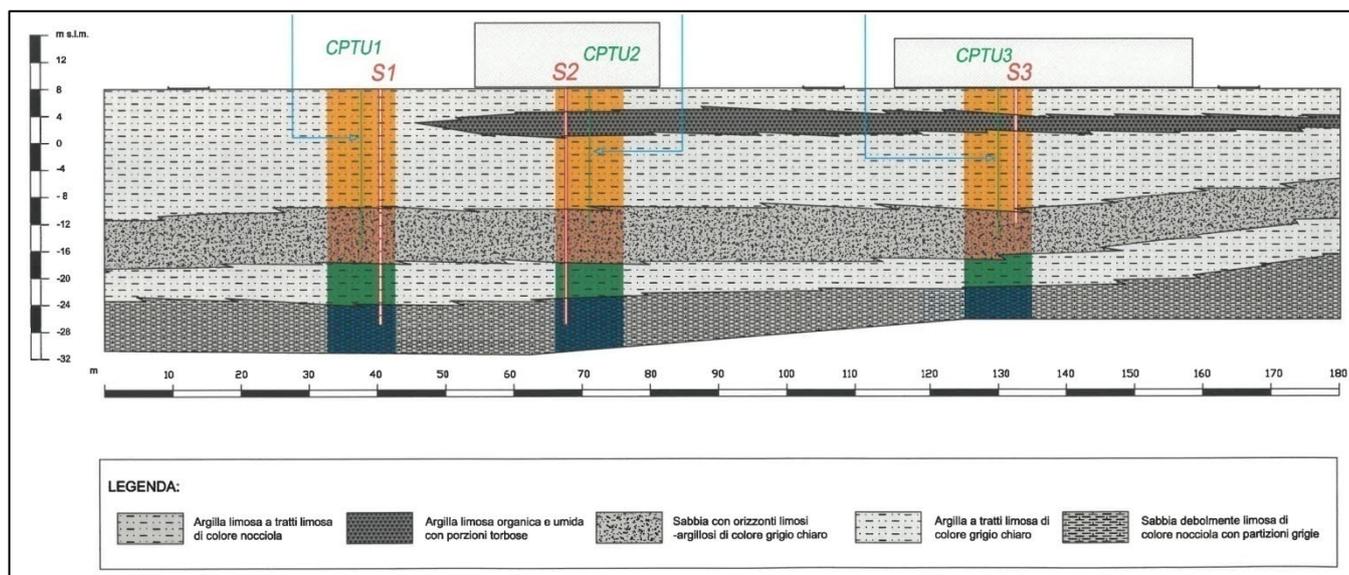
Sezione stratigrafica Centrale Poggio Renatico (*allineamento direzione nord-sud*)
